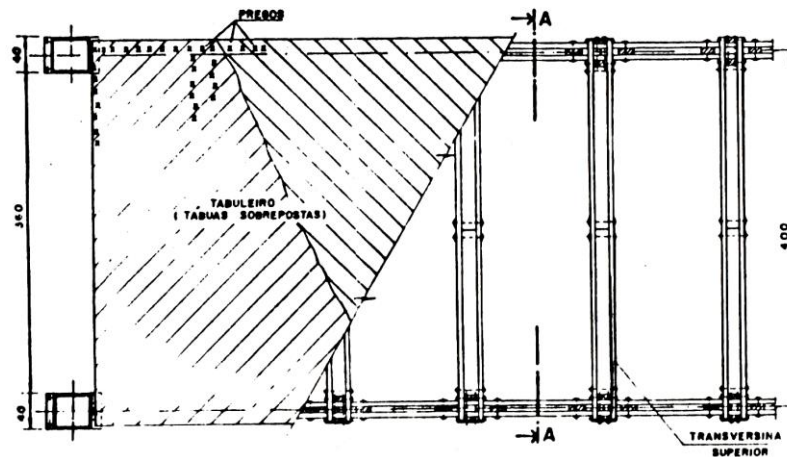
Detalhes do tabuleiro: Vista em Planta. Fonte: (CALIL JUNIOR et al. 1993)
